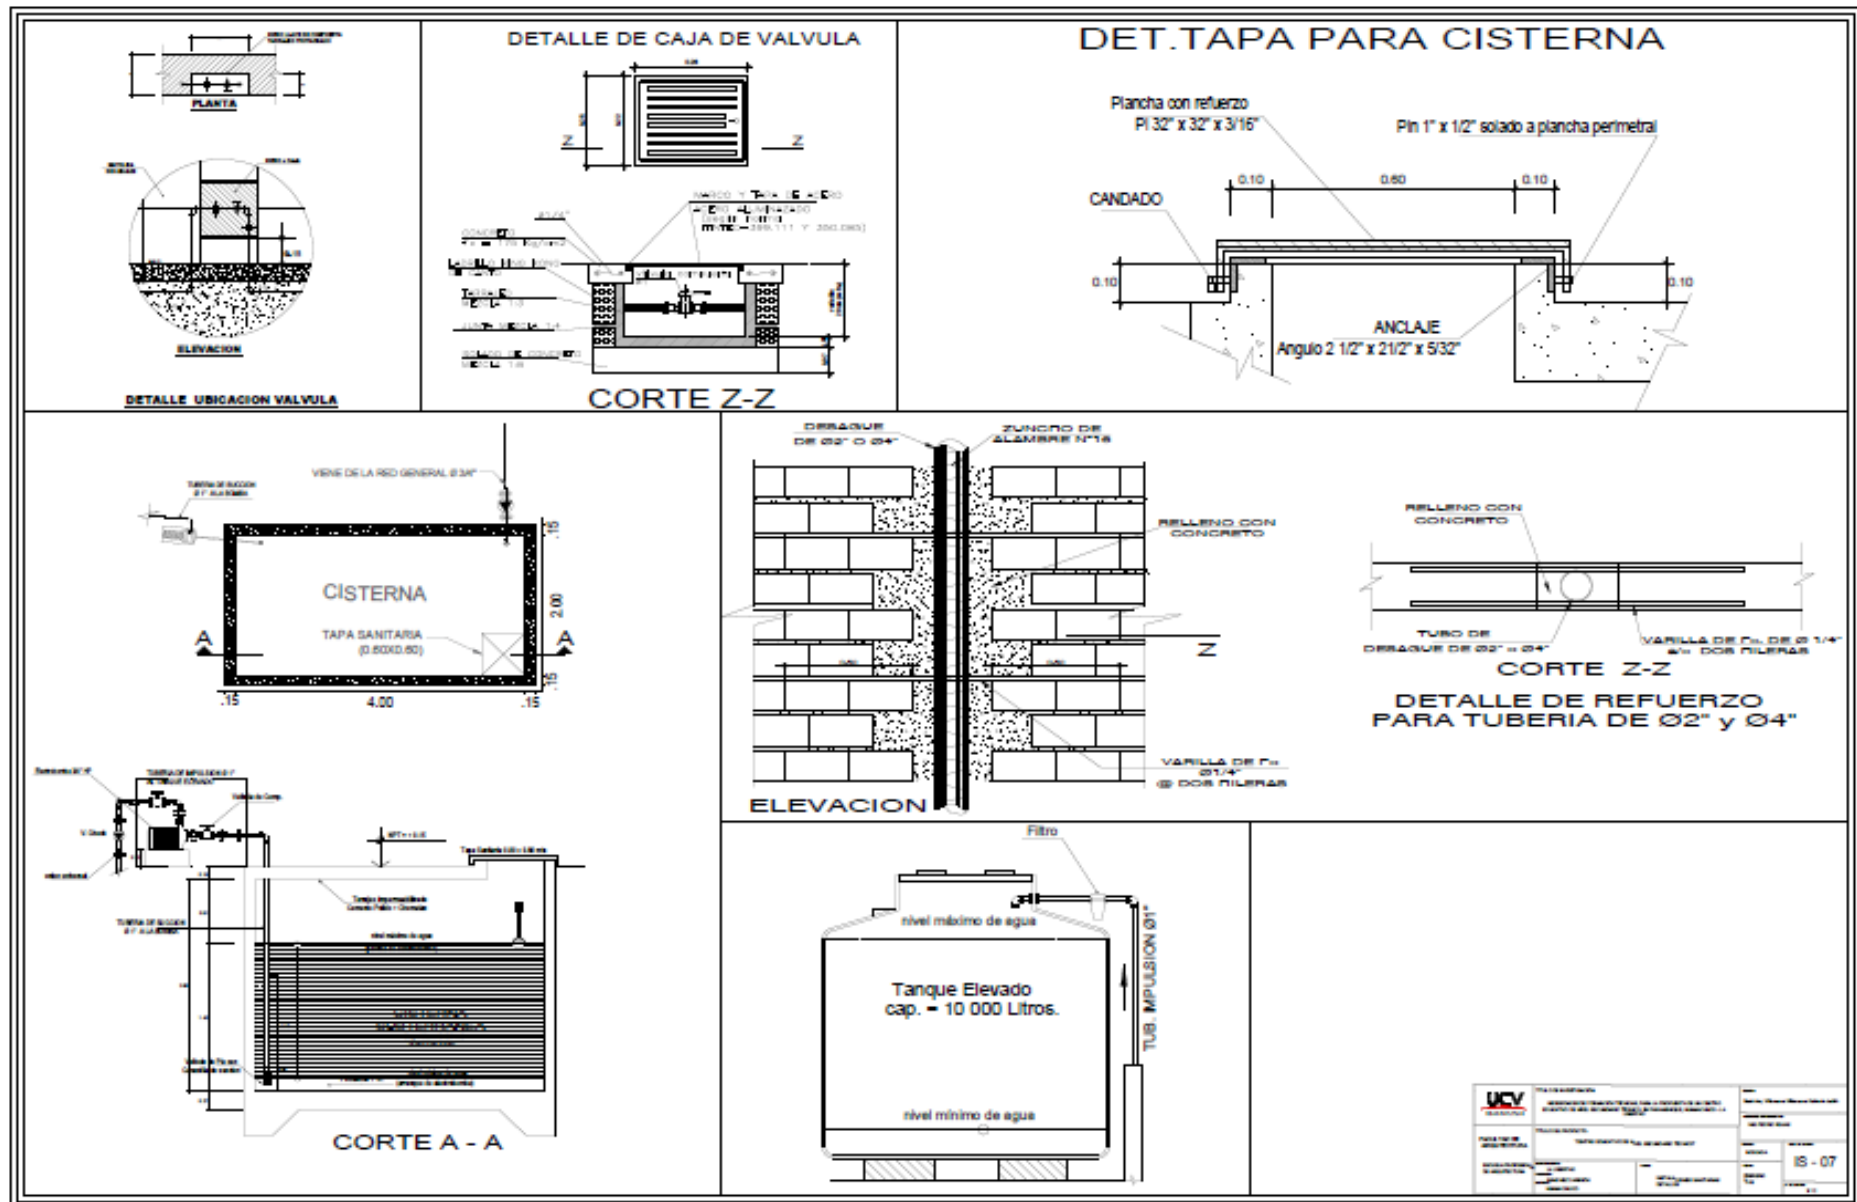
Plano de Diseño de Instalaciones Básicas Detalles – Agua - Plano N° 27 - Lamina IS-07
